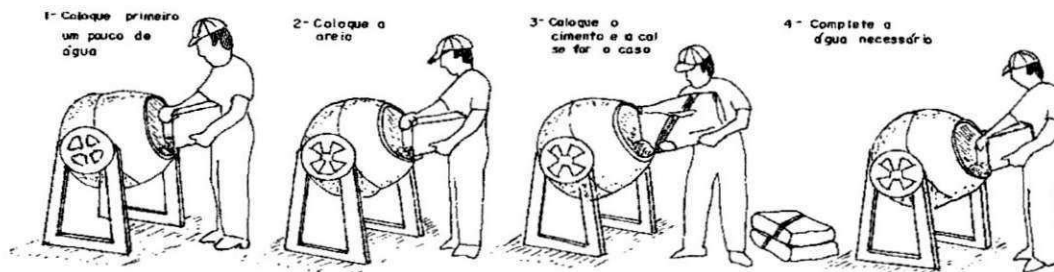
Preparação da argamassa de assentamento de alvenaria com betoneira
